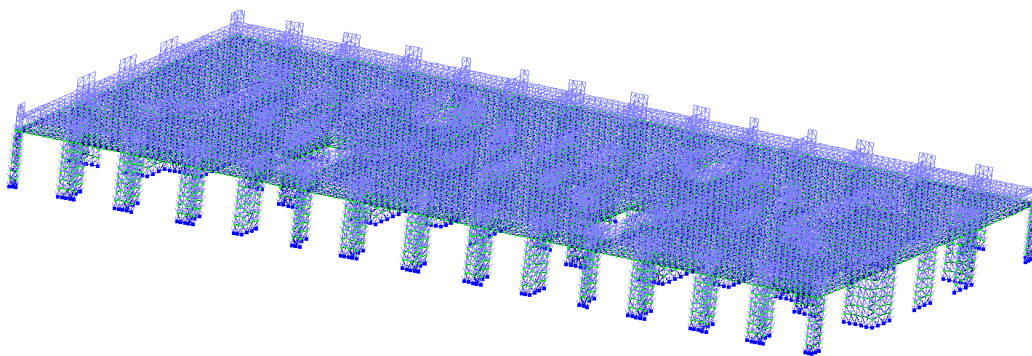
Розрахункова схема плити перекриття у LiraSAPR
